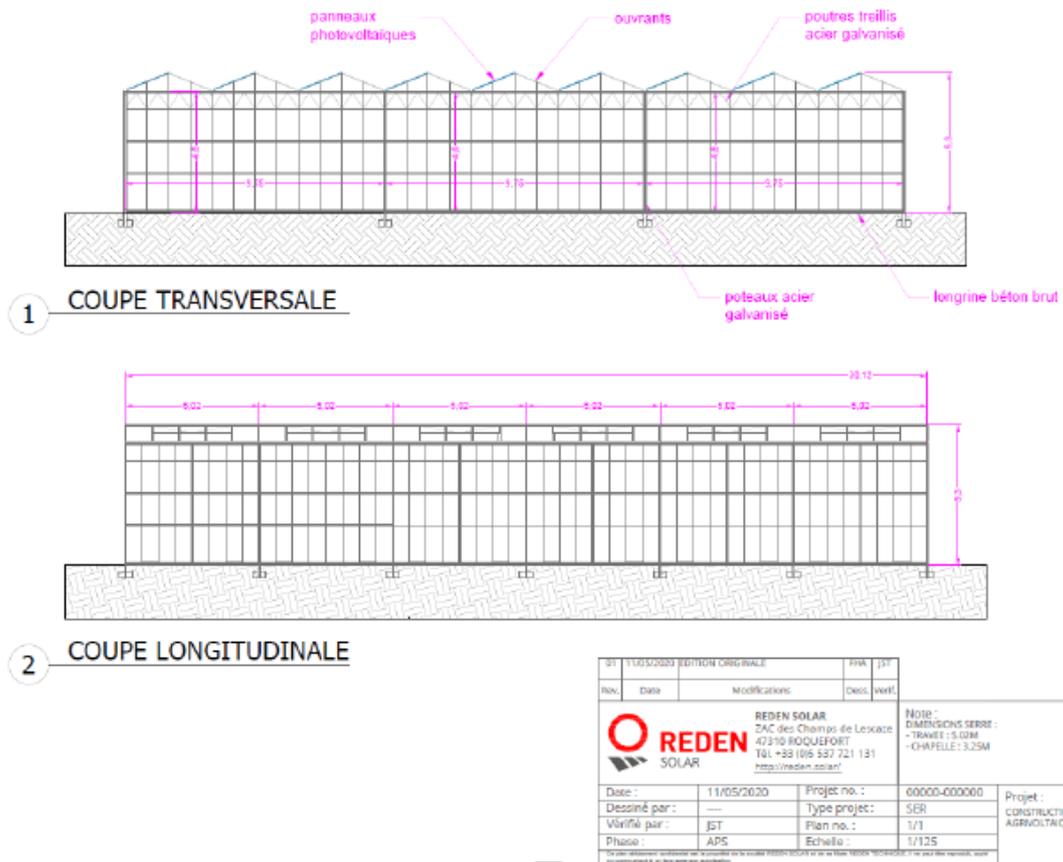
Coupes transversale & longitudinale type serre multi-chapelles - Source : Reden
